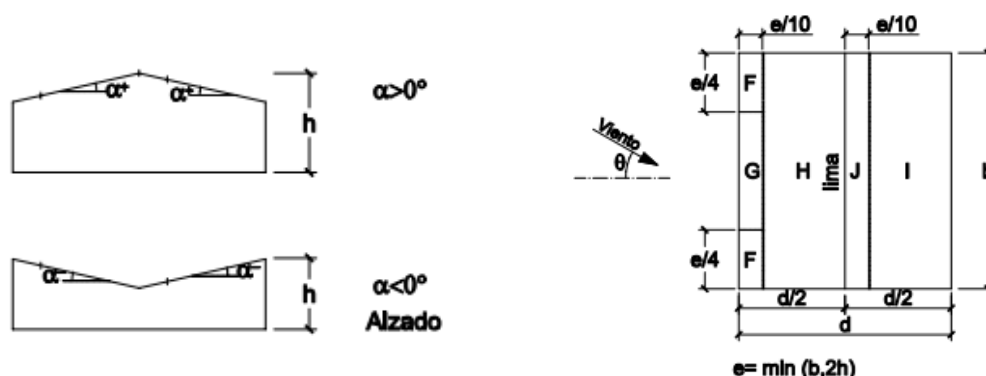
Determinación de regiones en cubierta con viento a 0° . Alzados y planta de la nave (6).
